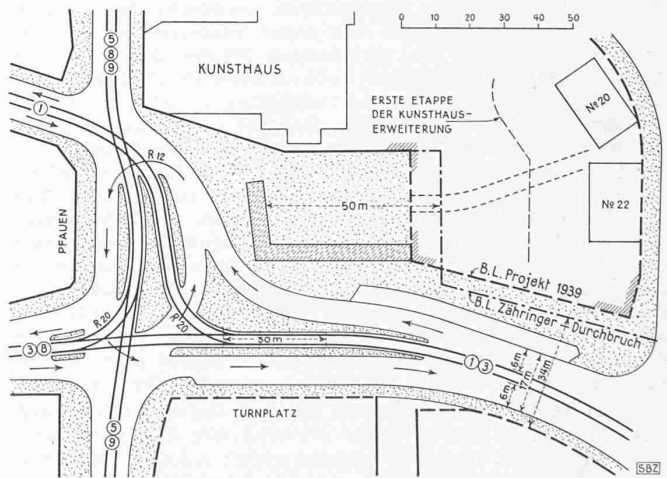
Anordnung der Strassenbahn-Linie 1 mit Minimalradius und Kunsthaus-Vorhof mit Fussgänger-Durchgang, 1 : 2000
